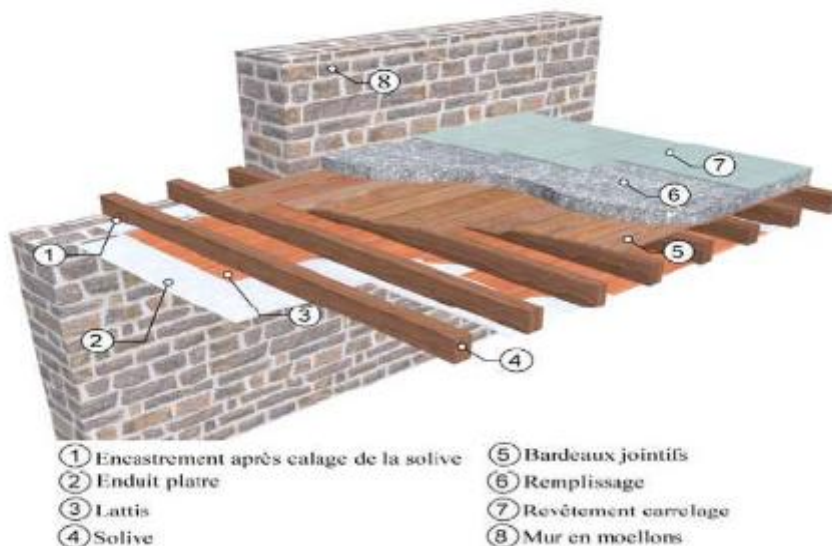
Détail d'une structure traditionnelle : mur porteur en moellons avec plancher en bois.
